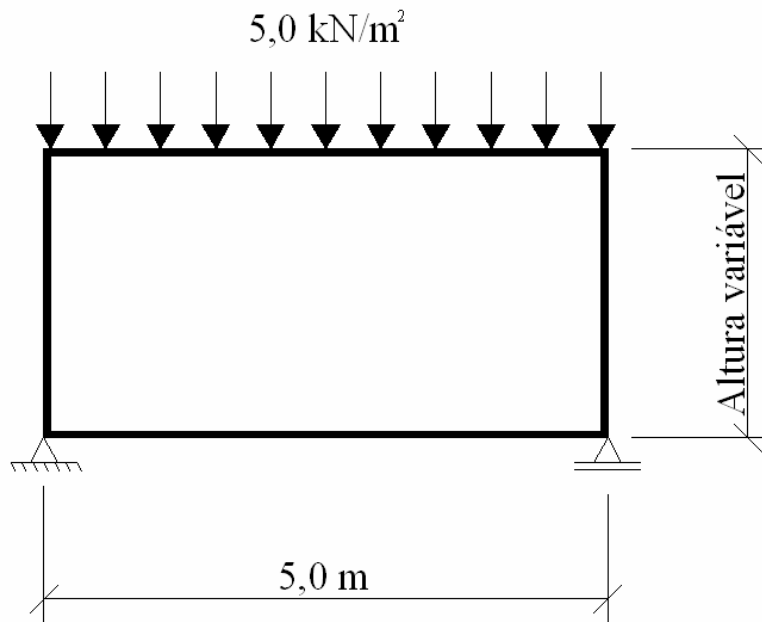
Viga biapoiada com carregamento uniformemente distribuído.
